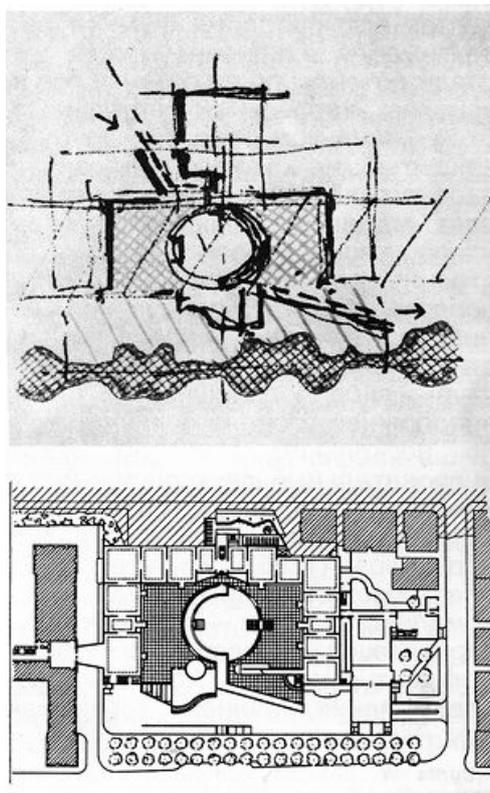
Neue Staatsgalerie, Stirling e Wilford, Pianta (<https://www.pinterest.it/>)
